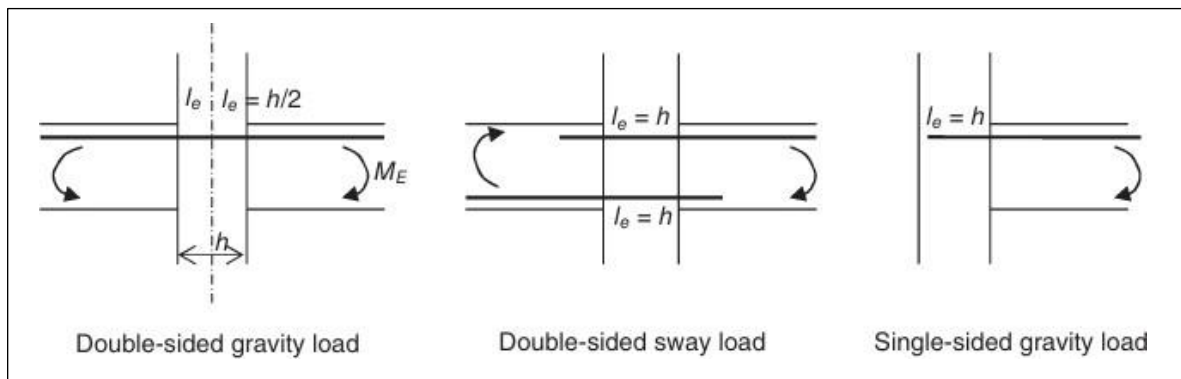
Longueur d'ancrage des armatures à travers les poteaux [36].
